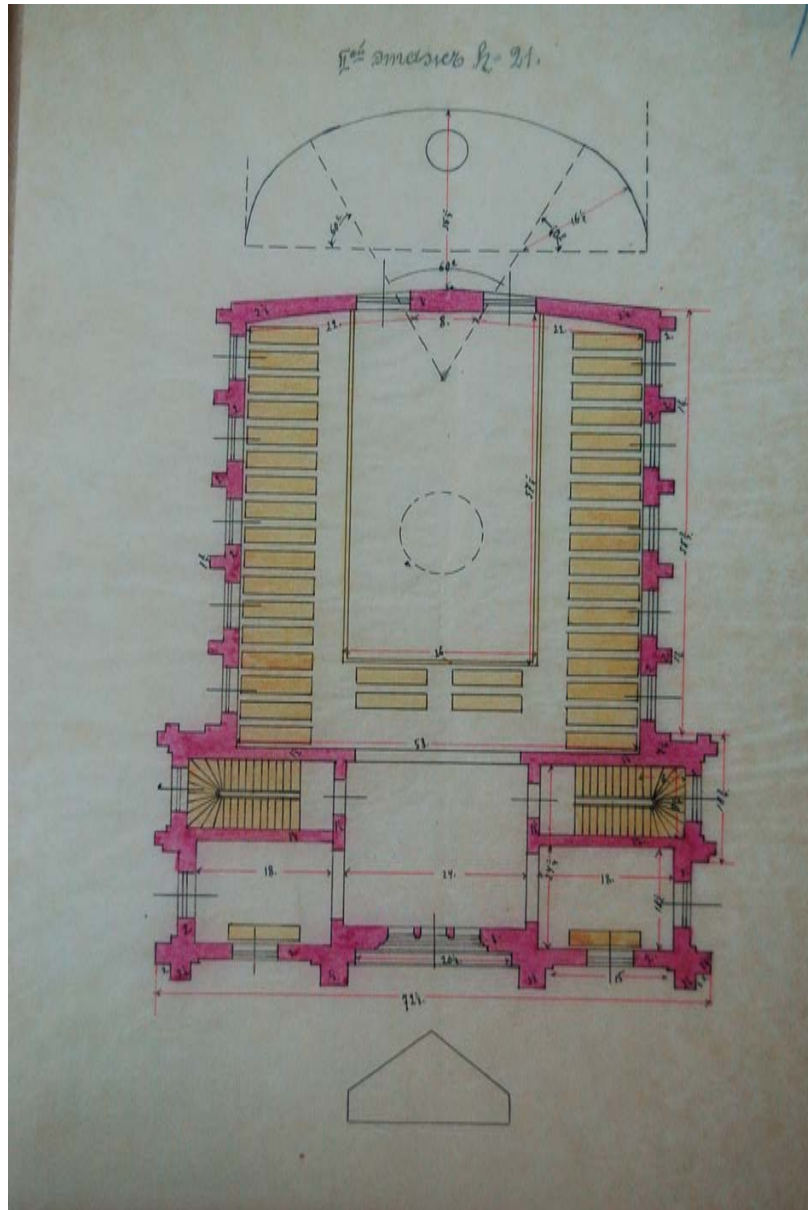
Grundriss 1. Obergeschoss (Frauengalerie), Archiv
